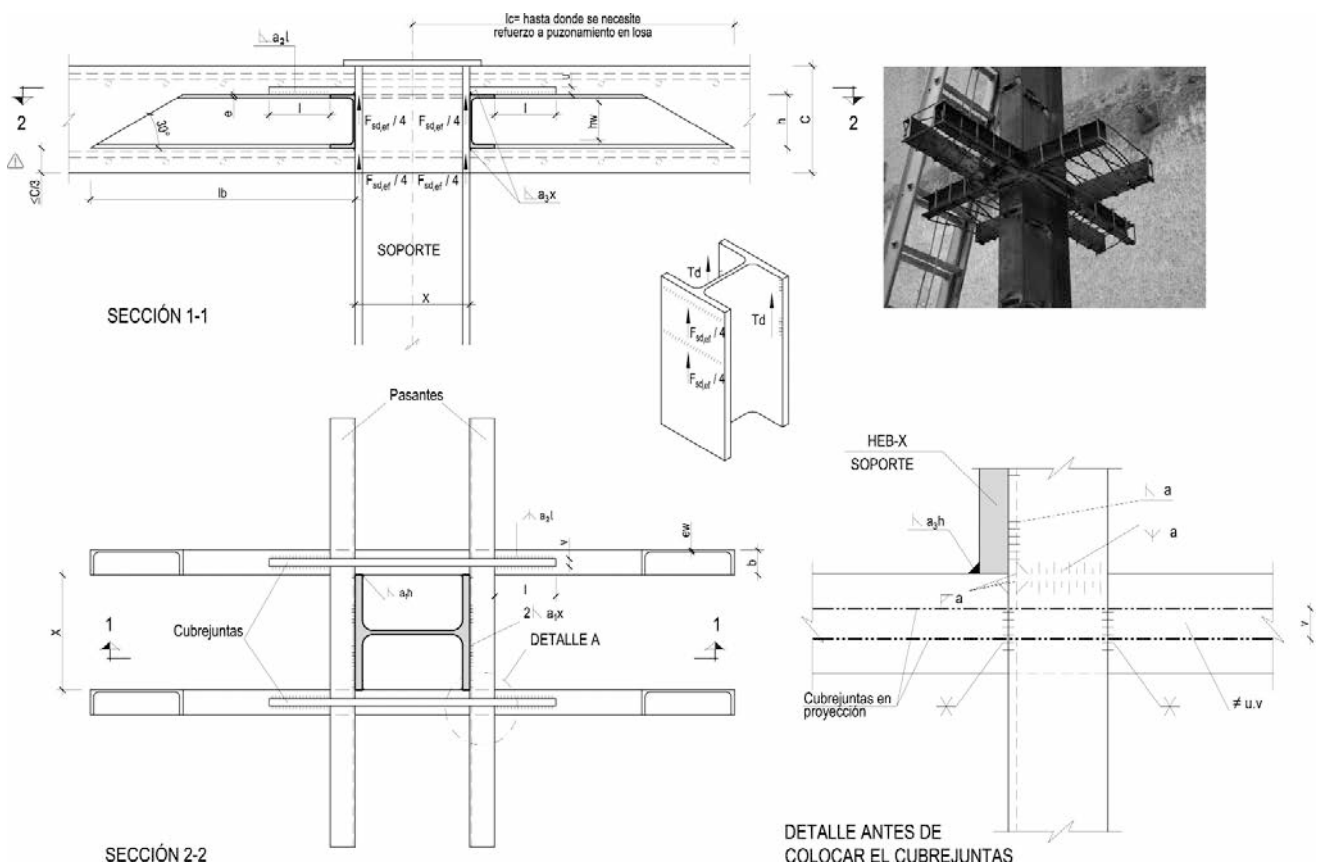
Detalle tipo tradicional de conexión de soporte metálico con losa de hormigón mediante crucetas metálicas
